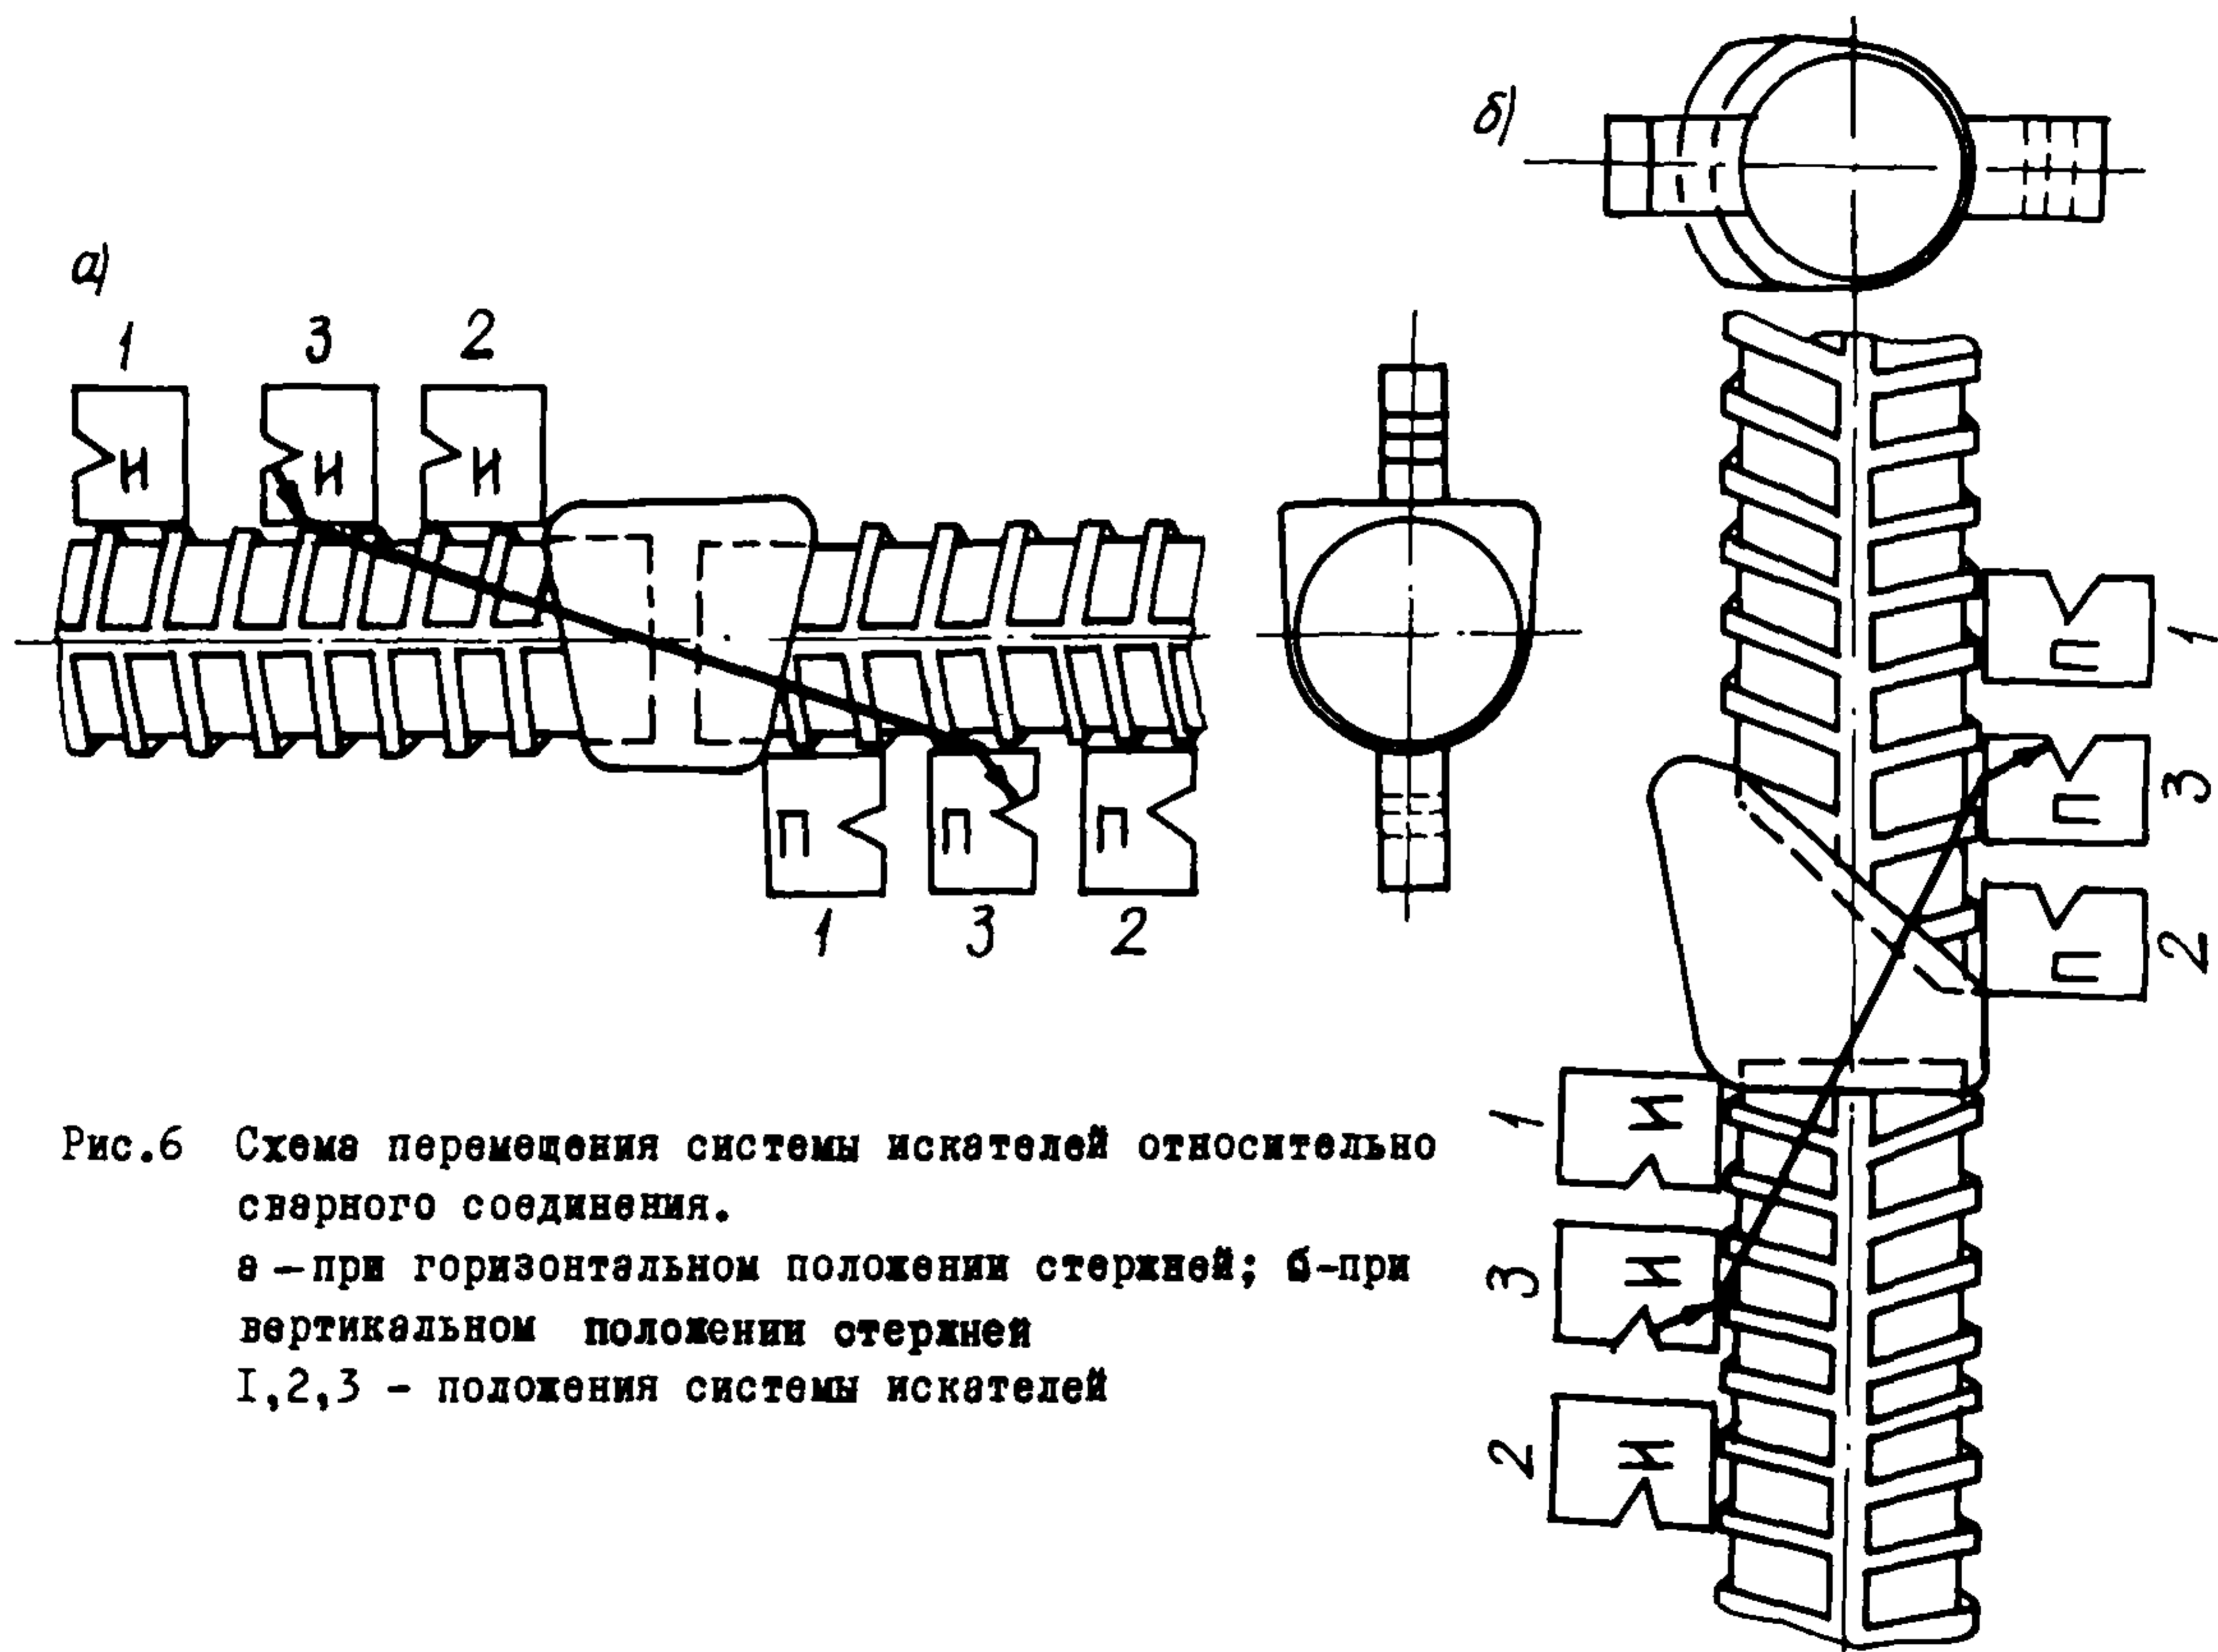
Схема перемещения системы икателей относительно сварного соединения.
